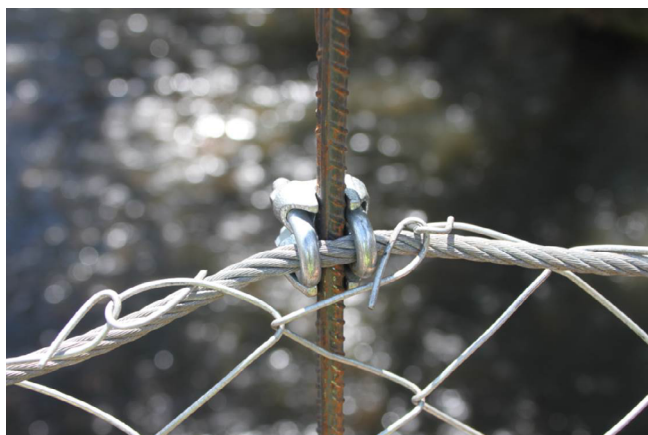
Detalle de conexión de la malla metálica propuesto por FHECOR e implementado en la pasarela San Vicente.
